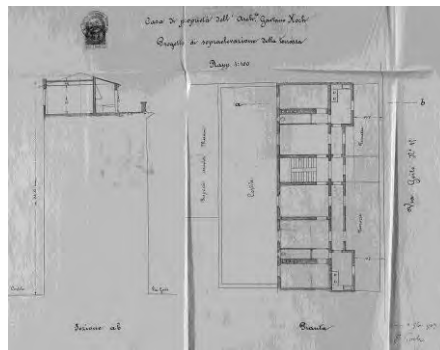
casa di Proprietà Koch sopraelevazione pianta e sezione
